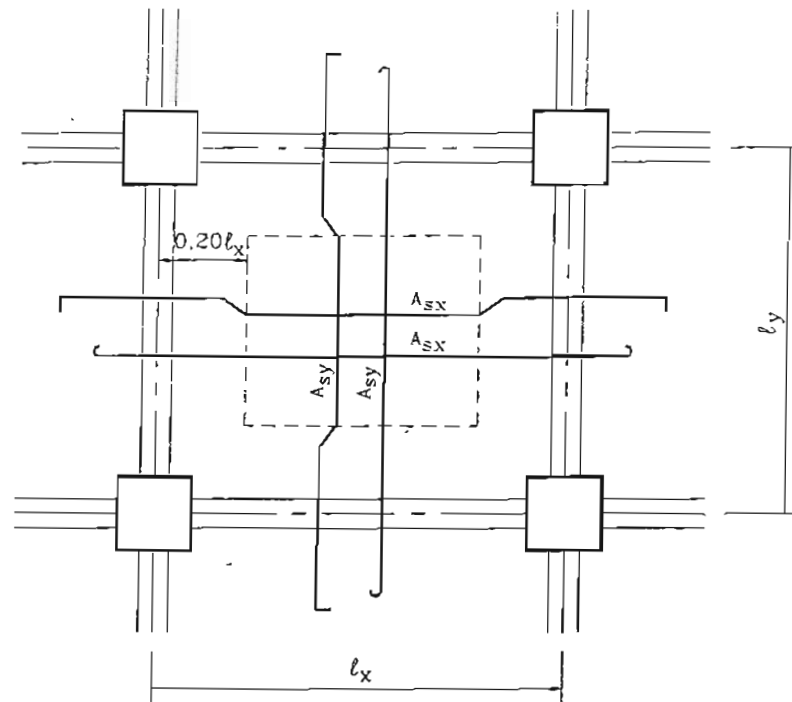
Detalhes de armaduras com barras dobradas para lajes contínuas [FUSCO, 1994]
